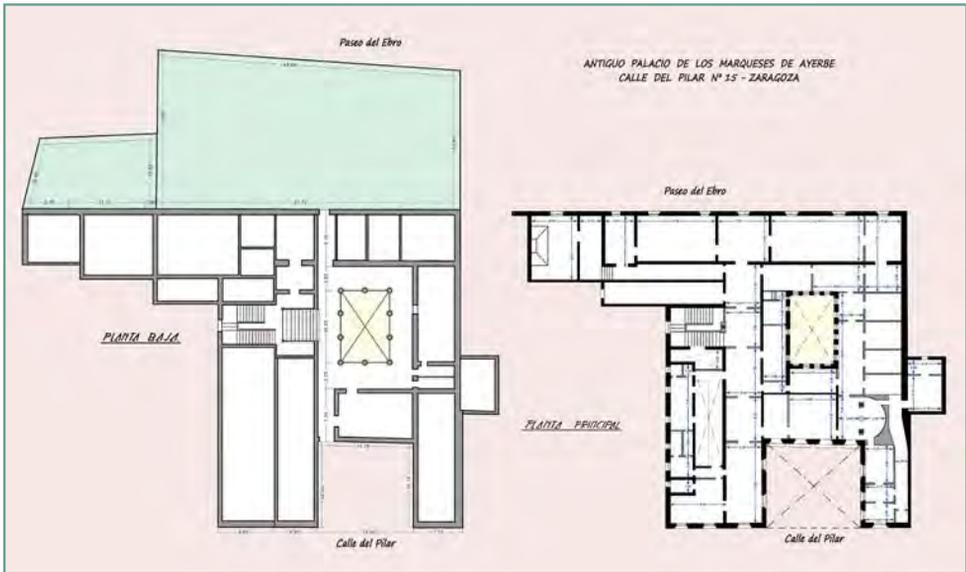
Plano de las plantas baja y principal de la casa del Marqués de Ayerbe en el momento de su derribo (mediciones realizadas por M.Á. Navarro).
